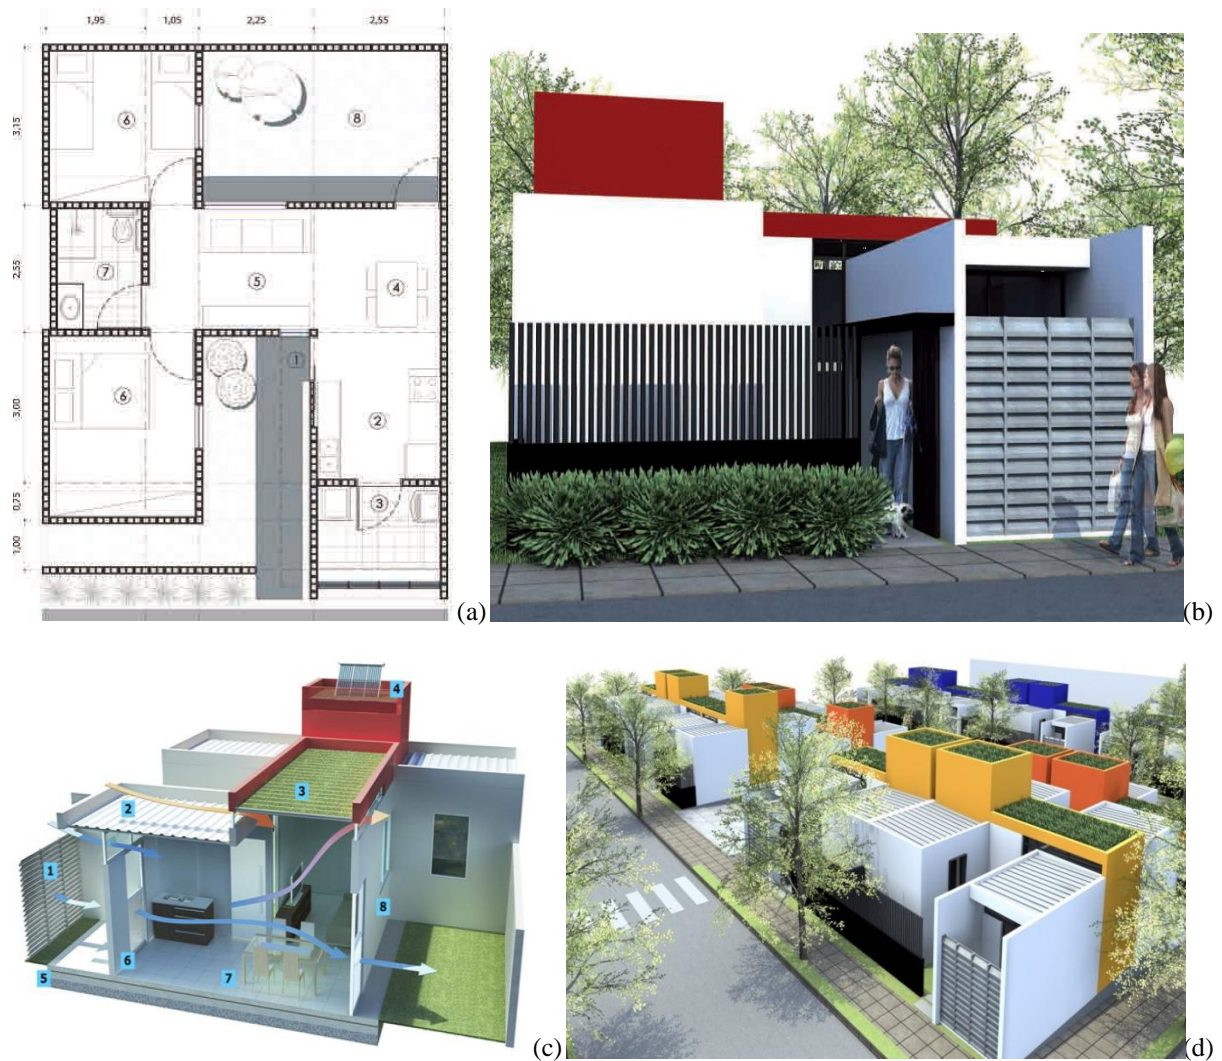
Projeto correlato. (a) planta baixa, (b) fachada, (c) corte esquemático, (d) implantação geral.
